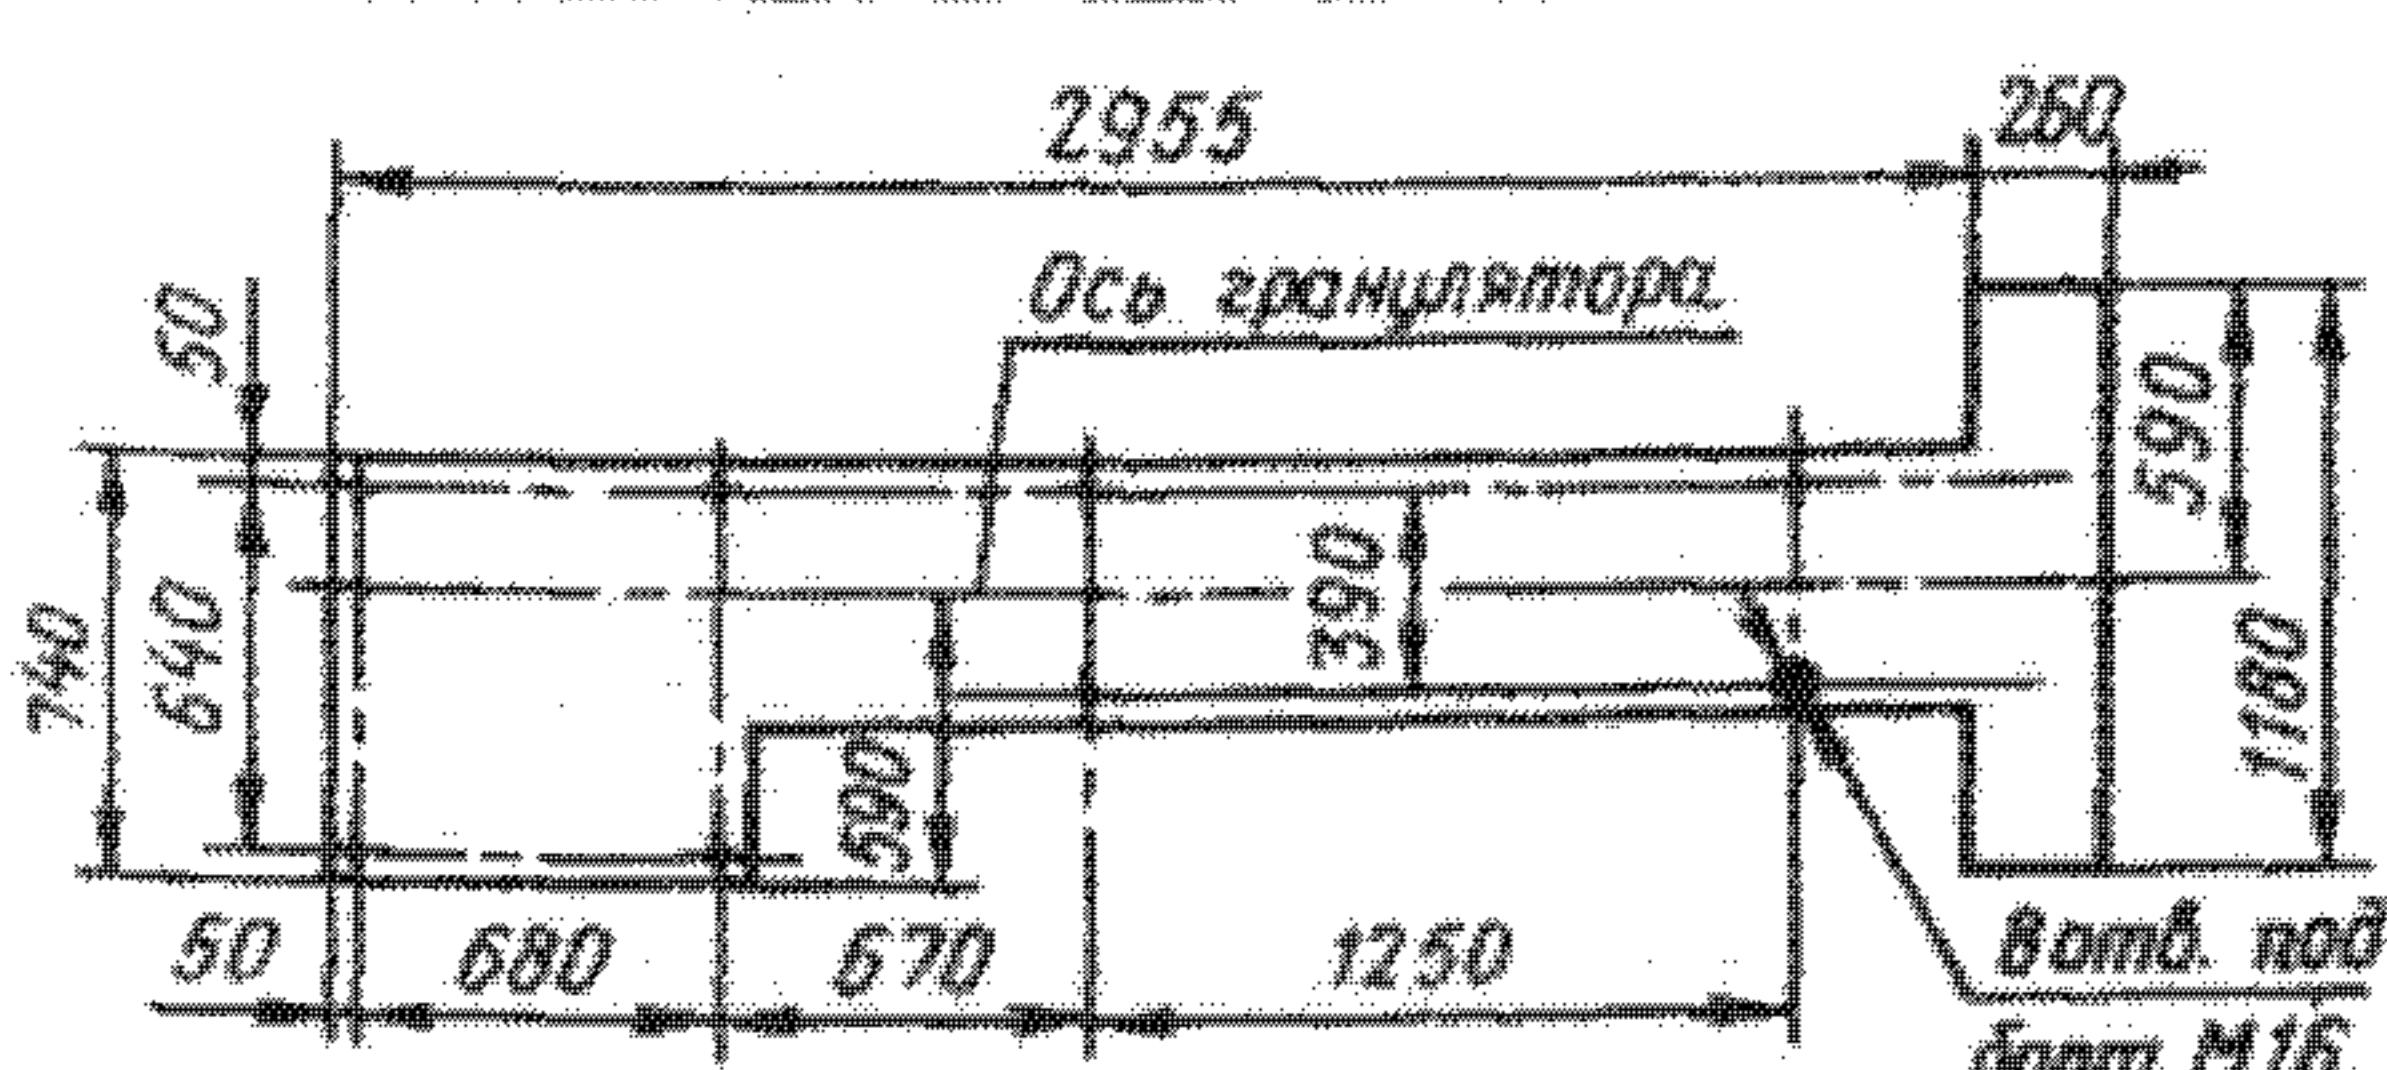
План расположения отверстий под фундаментные болты гранулятора
